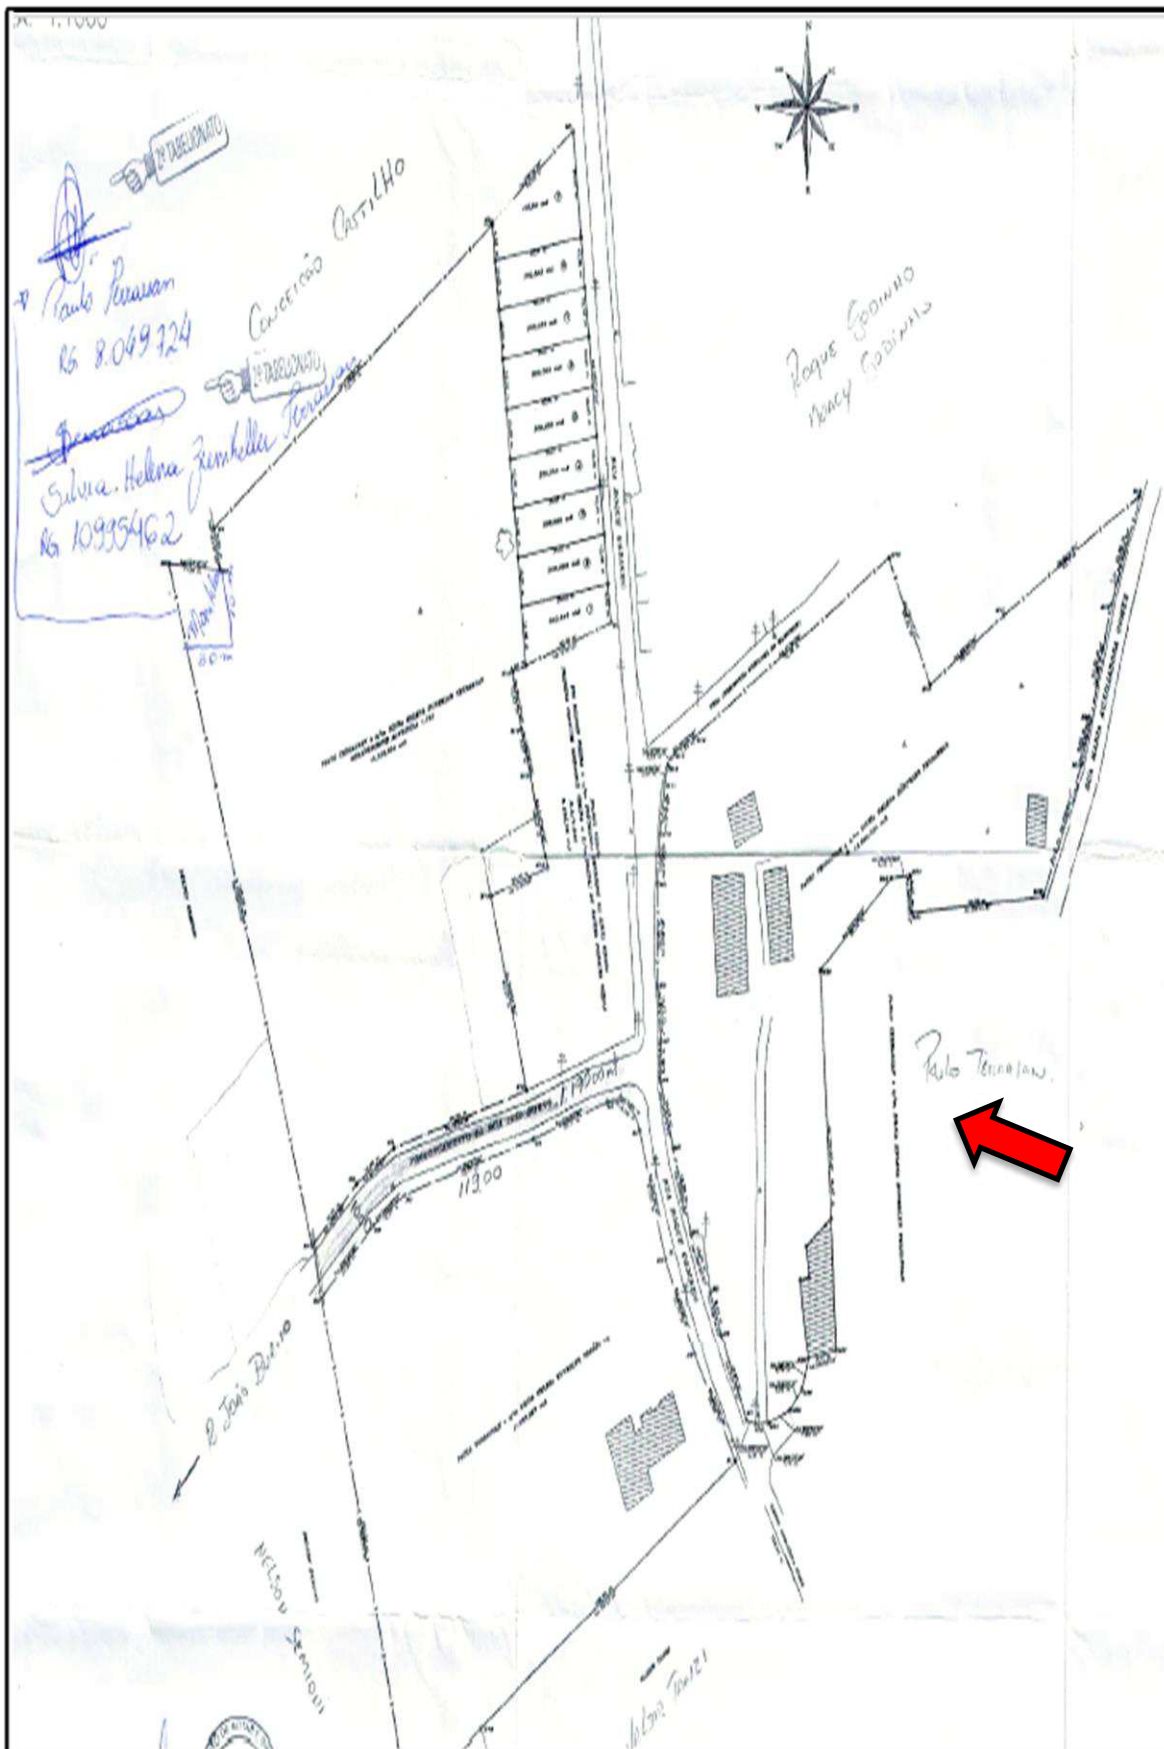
Outra vista das benfeitorias (cópia extraída de outro processo).
